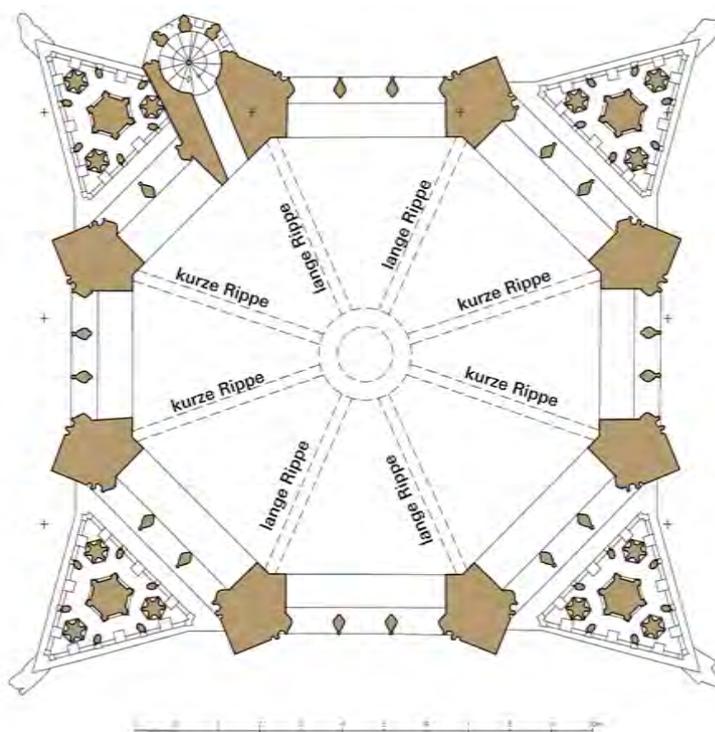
Grundriss durch die Oktogonhalle mit eingetragenen Gewölbe unter der Lauffebene. Aufgrund der Stauchung ergeben sich kurze und lange Diagonalrippen
